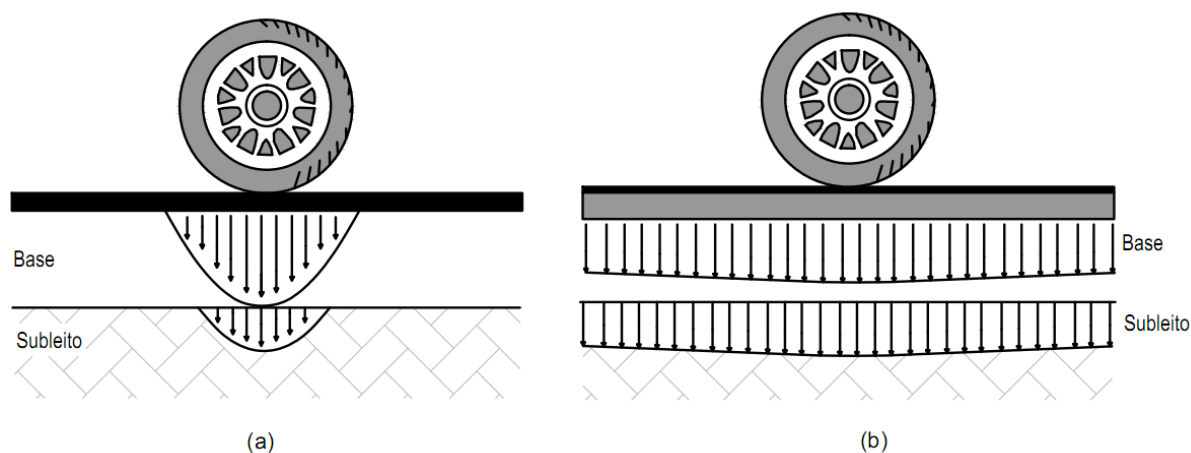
(a) campo de tensões de pavimento flexível; (b) campo de tensões de pavimento rígido (adaptado de BALBO, 2007, p. 47)
